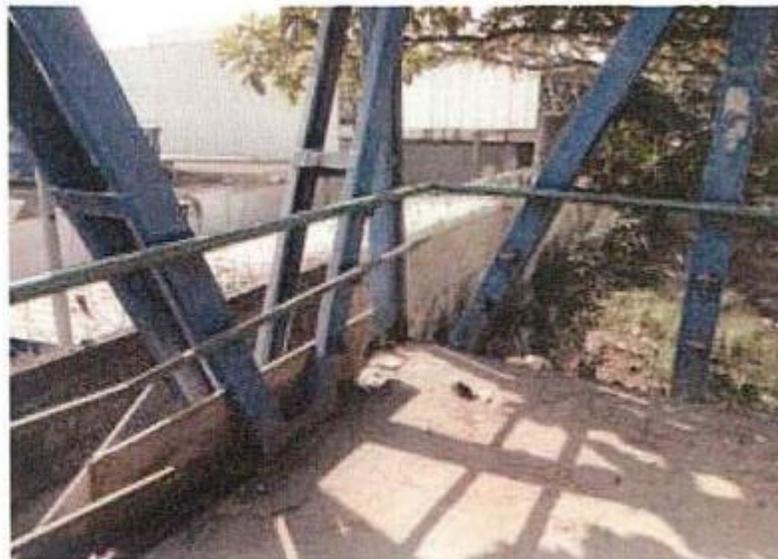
Passarela do km 118 - Sujeira acumulada - elementos de proteção corroídos e ausentes
